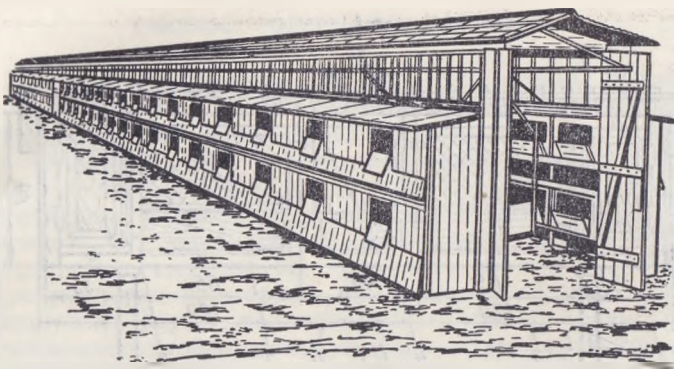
Наружный вид шед с двухъярусным расположением клеток.
